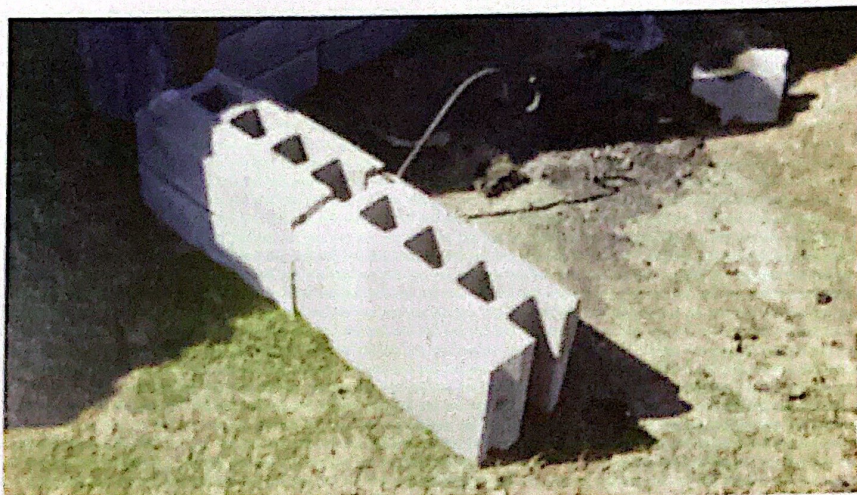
Bloque autotrabante para la autoconstrucción. Arq. Ricardo Muttoni
